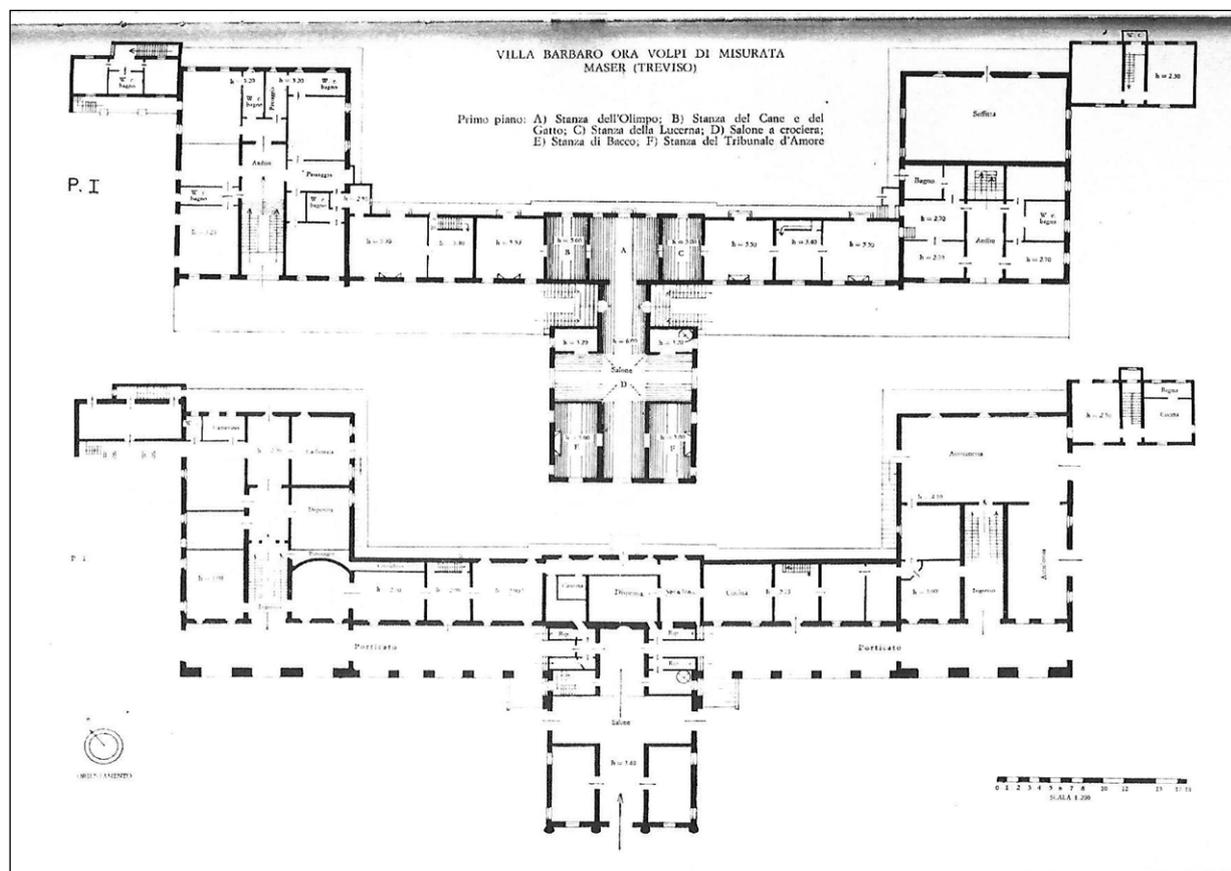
Plantas baixas do primeiro e segundo pavimento da Villa Barbaro. Fonte: Zorzi, 1969.
